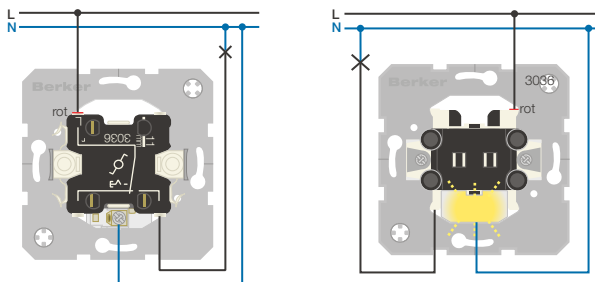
Beleuchtet bei EIN, Ausschaltung mit Wechselschalter (Kontaktzunge am Glühaggregat entfernen)
